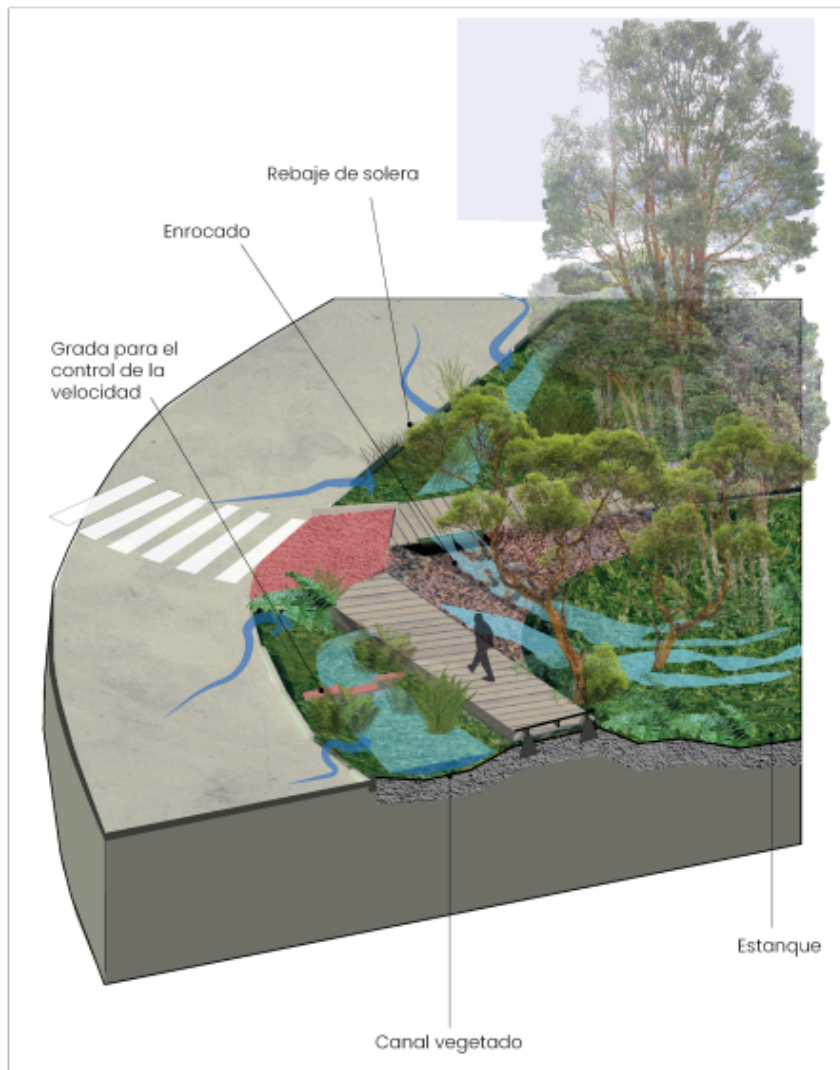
, Detalle del empalme entre la calle y plaza por medio de rebaje de soleras y canal veteado.
